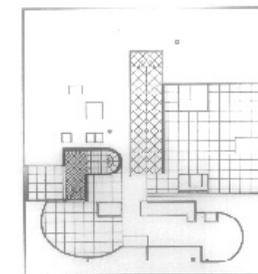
Le Corbusier, Ville Savoye, Planta baixa do terceiro pavimento.
